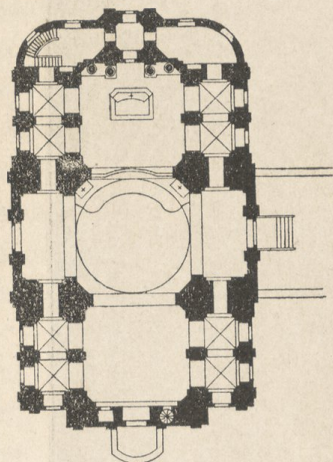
Büren, Jesuitenkirche. Grundriss.
